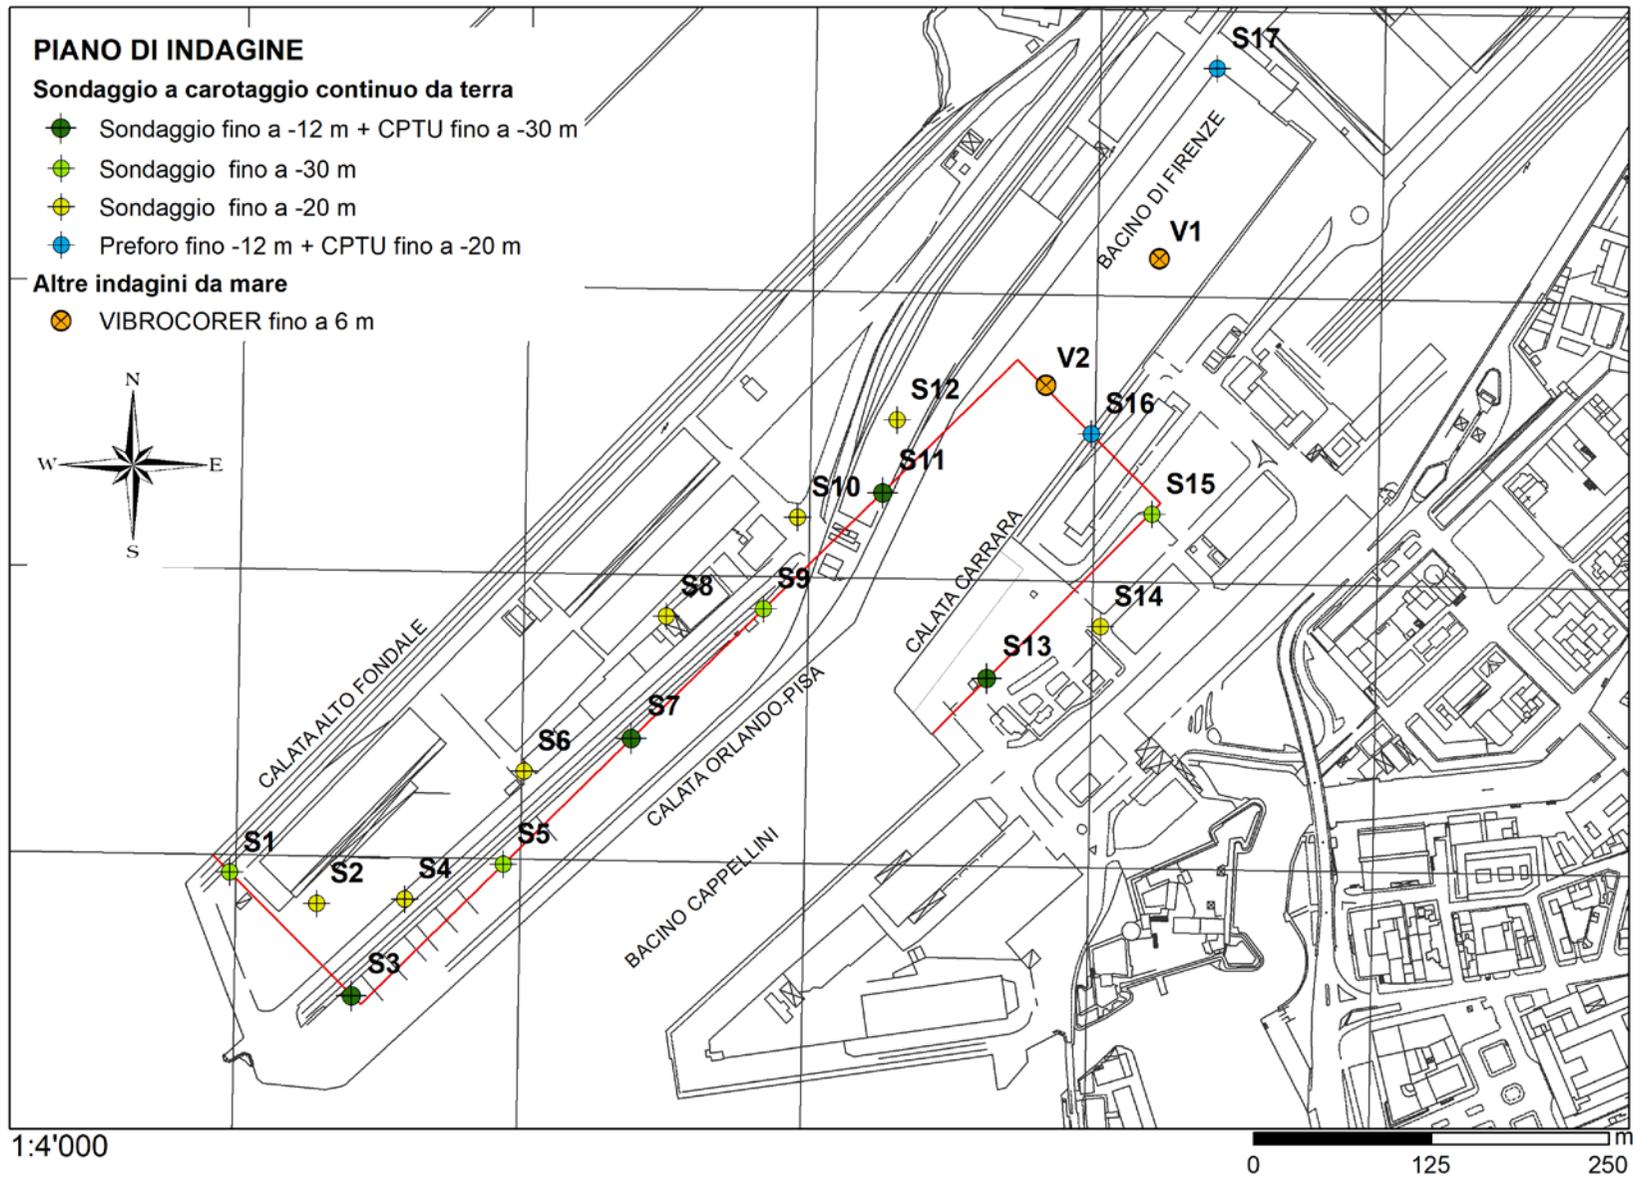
Planimetria ubicazione delle indagini. Le quote sono da intendersi dal piano campagna.
